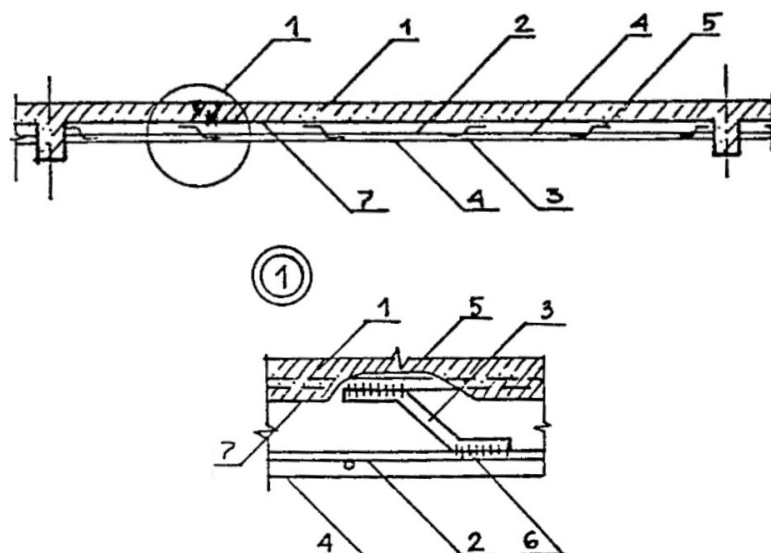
Збільшення несучої здатності плити перекриття за рахунок нарощування знизу: 1 – плита перекриття, яка підлягає підсиленню; 2 – арматура, яка працює у підсиленому шарі; 3 – відгини з арматури; 4 – торкретбетон підсилення; 5 – вилучений захисний шар бетону; 6 – ділянки зі зварюванням; 7 – нижня площина плити
